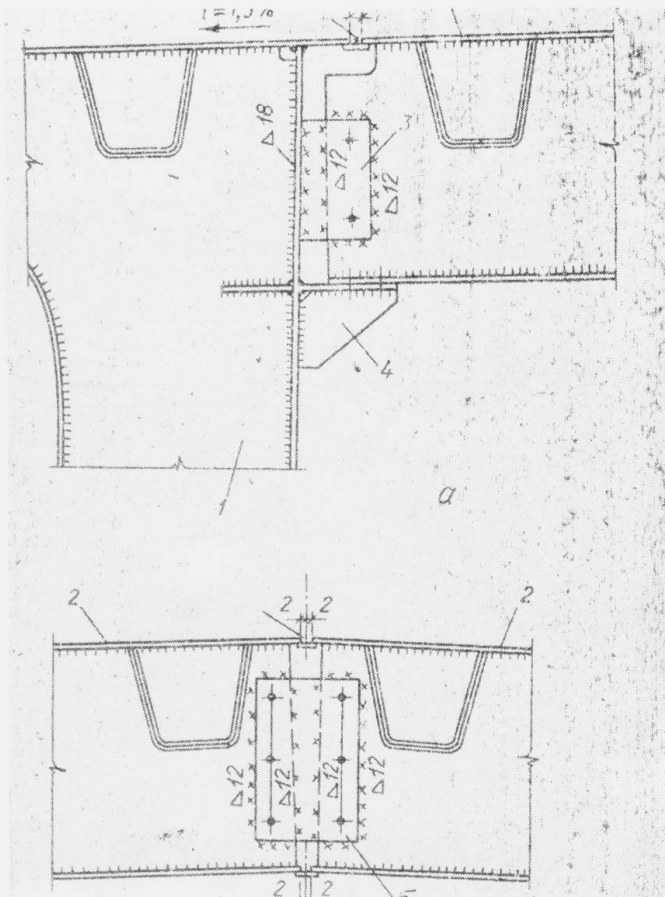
Les noeuds de raccordement des entretoises de dalle orthotrope; a) avec des caissons de la poutre principale; b) entre eux-mêmes; 1 - poutre principale; 2 - entretoise de dalle orthotrope; 3 - le couvre-joint de montage; 4 - l'appui de montage.
